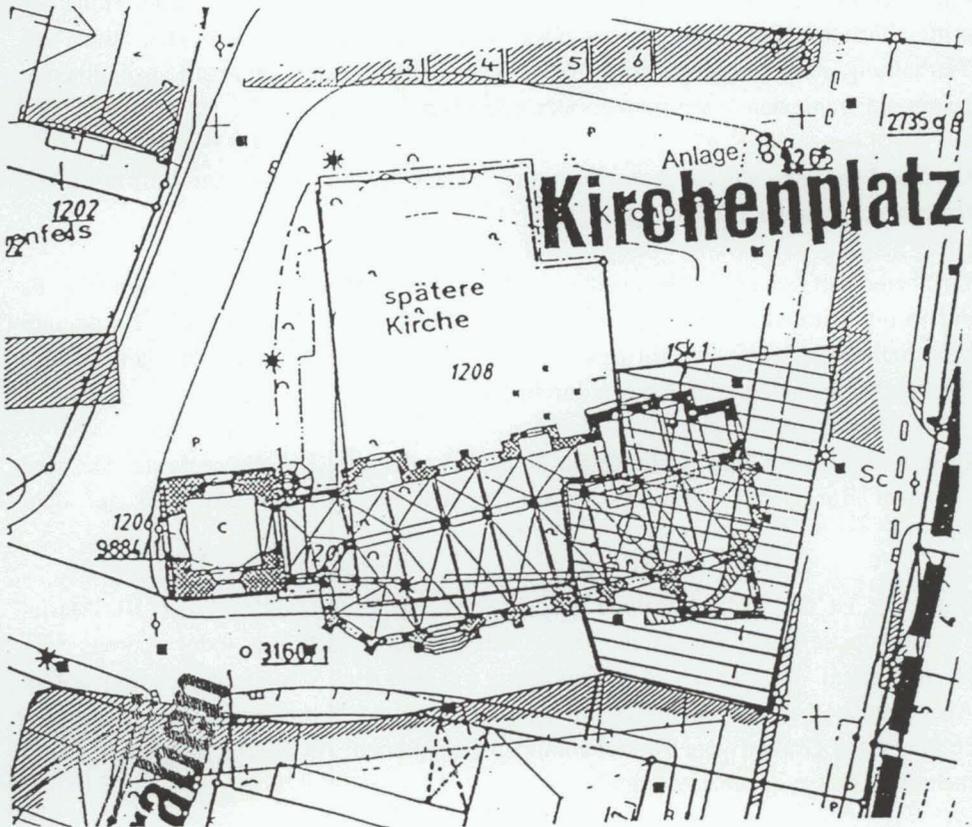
Lageplan der Stadtkirche des Stadtplanungsamtes (1992) auf Grundlage der Grundrißzeichnung von 1811, in: Walbe, a.a.O., S. 132
